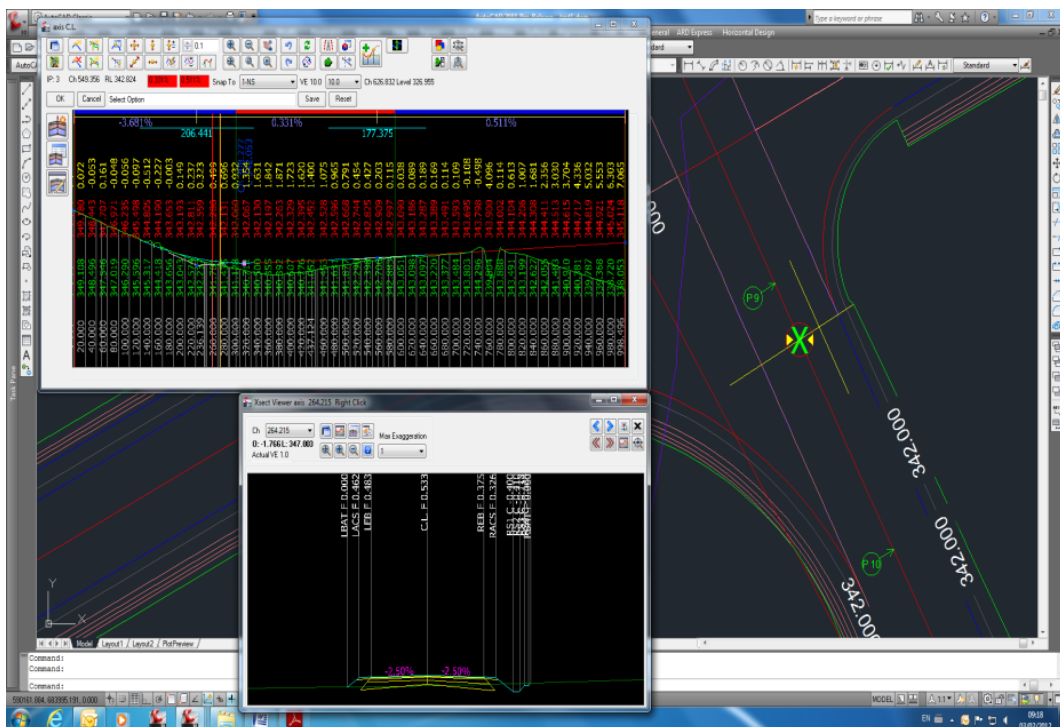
12 Corelarea instantanee a elementelor din cele trei proiecții ale drumului, plan de situație, profil longitudinal și profil transversal [11]
